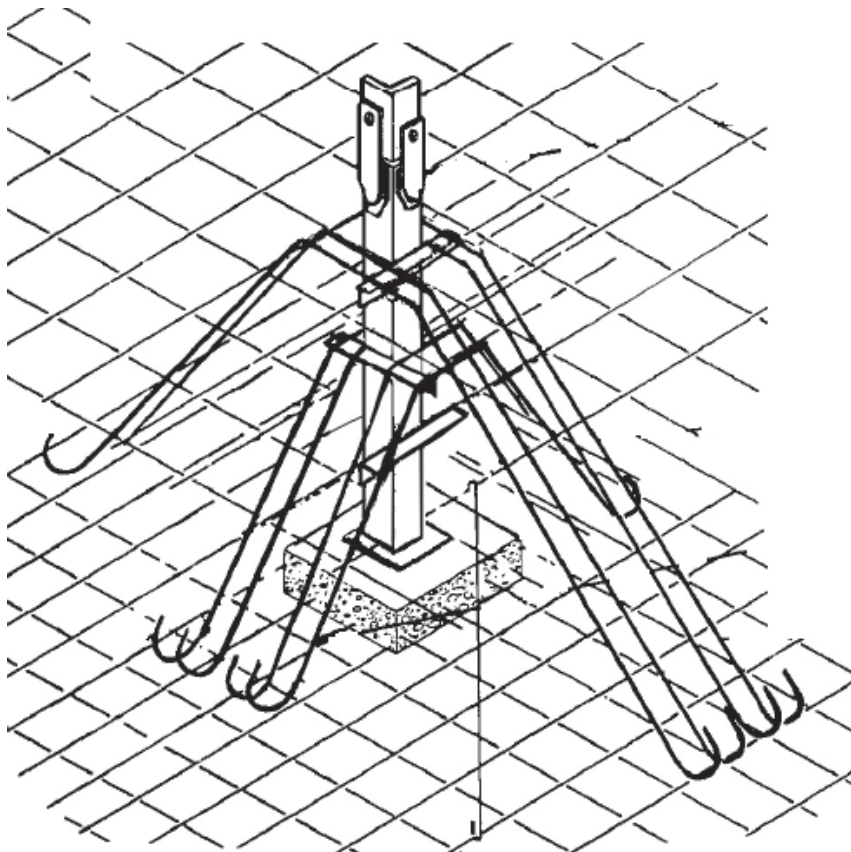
Detalle del forjado en el pie de empotramiento
